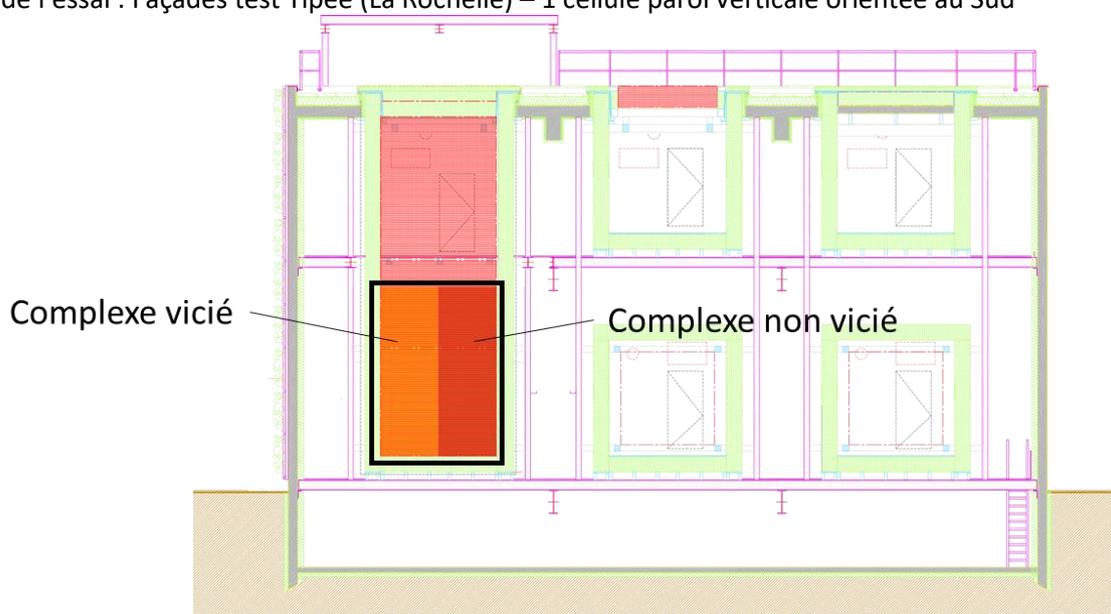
localisation de l'essai sur la façade test Tipee, schéma de principe de l'installation
